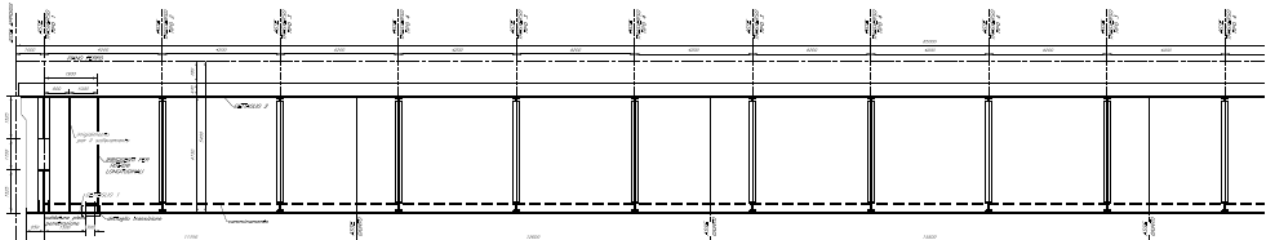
Profilo longitudinale dell'impalcato (1/2 impalcato, simmetrico rispetto alla mezzeria)
